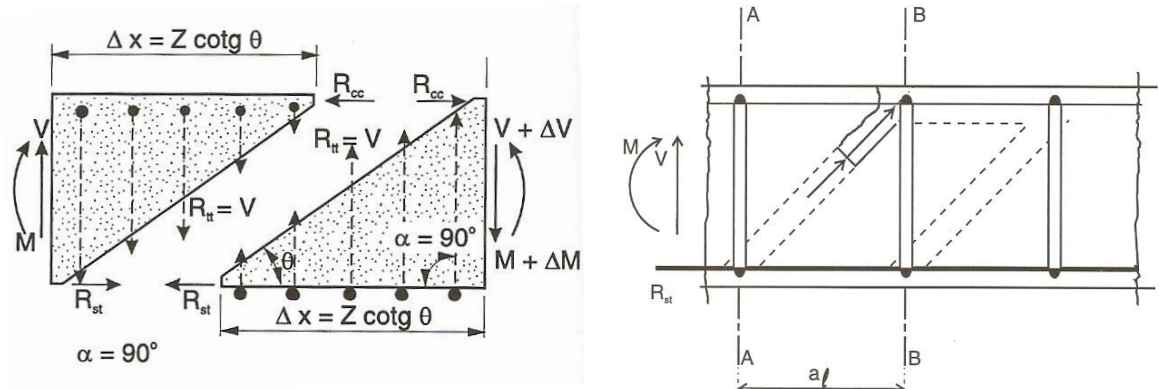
Esforços verticais e longitudinais de vigas de concreto armado (Fusco1995)
